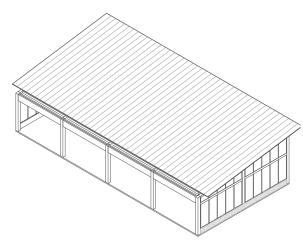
Axonometría estructural tipo 1_9 Fuente: Autores. 2024
